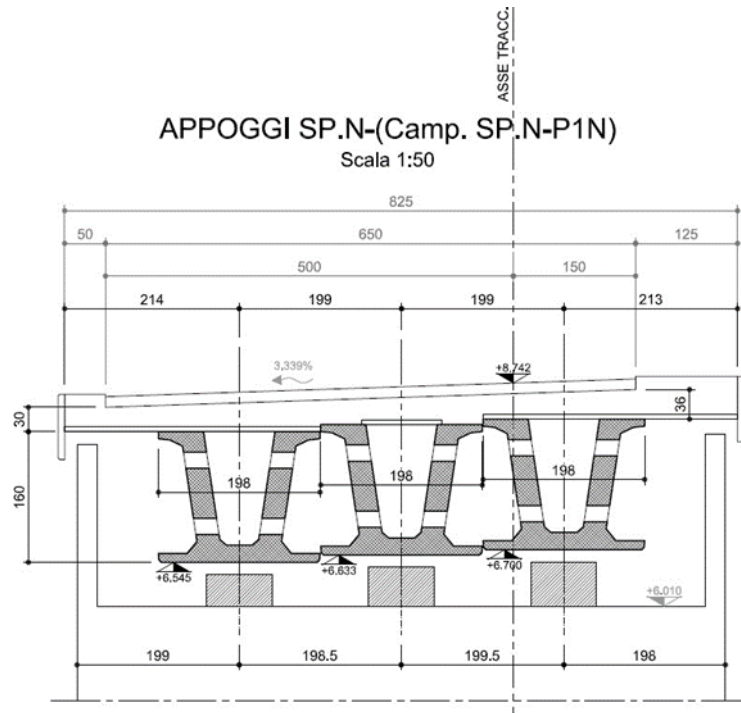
Sezione trasversale Campata 1 (a 3 travi) – Rampa N – SP_N
